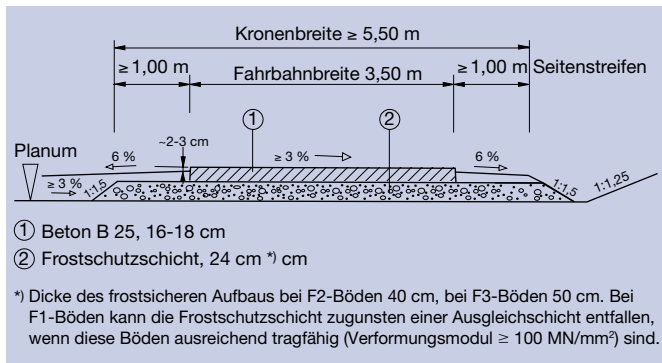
Regelquerschnitt eines einstreifigen Verbindungsweges mit Betondecke (größere Verkehrsbeanspruchung)
